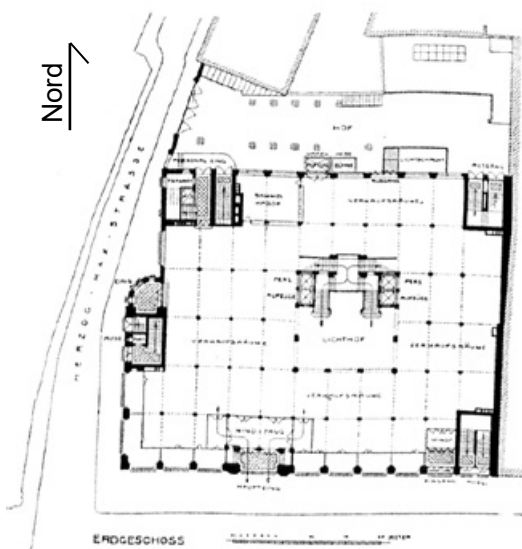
Grundriss (BAI 1912, S. 316).
